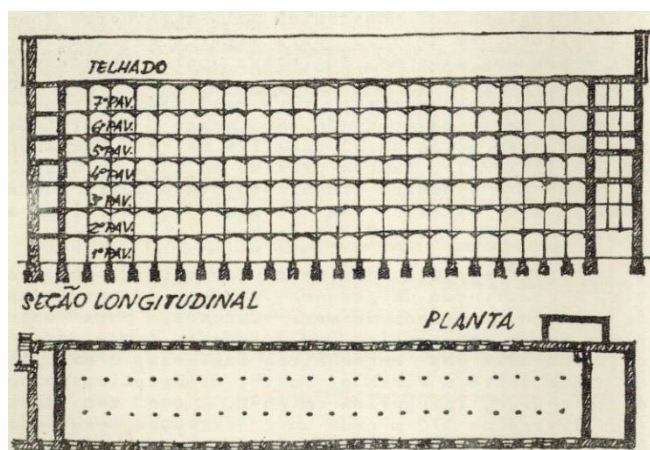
7: Planta e Seção longitudinal Fábrica Philips & Lee, em Salford, Manchester, 1801. Fonte: BOLTSCHAUER (1972).
